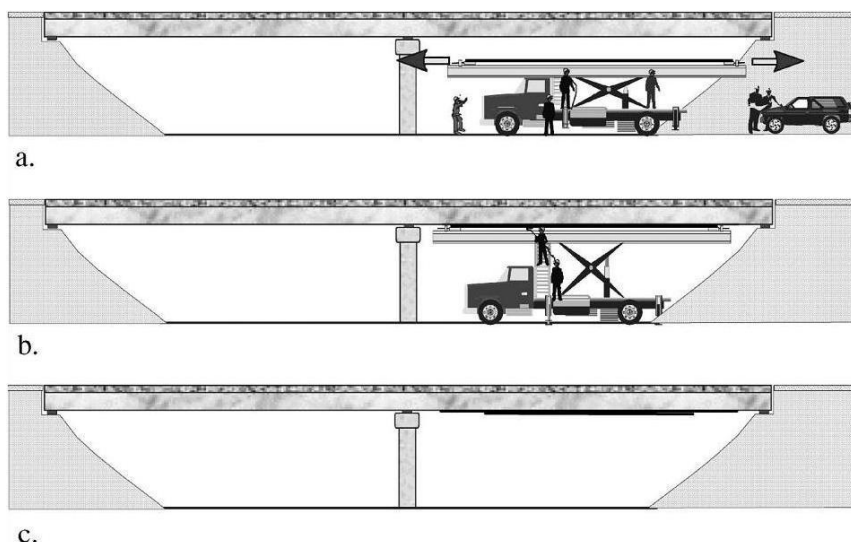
Aplicação de pré-esforço ao laminado por um equipamento independente à viga. a) Amarração e tração do laminado no aparelho de pré-esforço. b) Colagem do laminado tracionado. Cura da cola epoxídica. c) Corte do laminado nas ancoragens e transferência do esforço ao compósito (R El-Hacha, Wight, and Green 2001).
